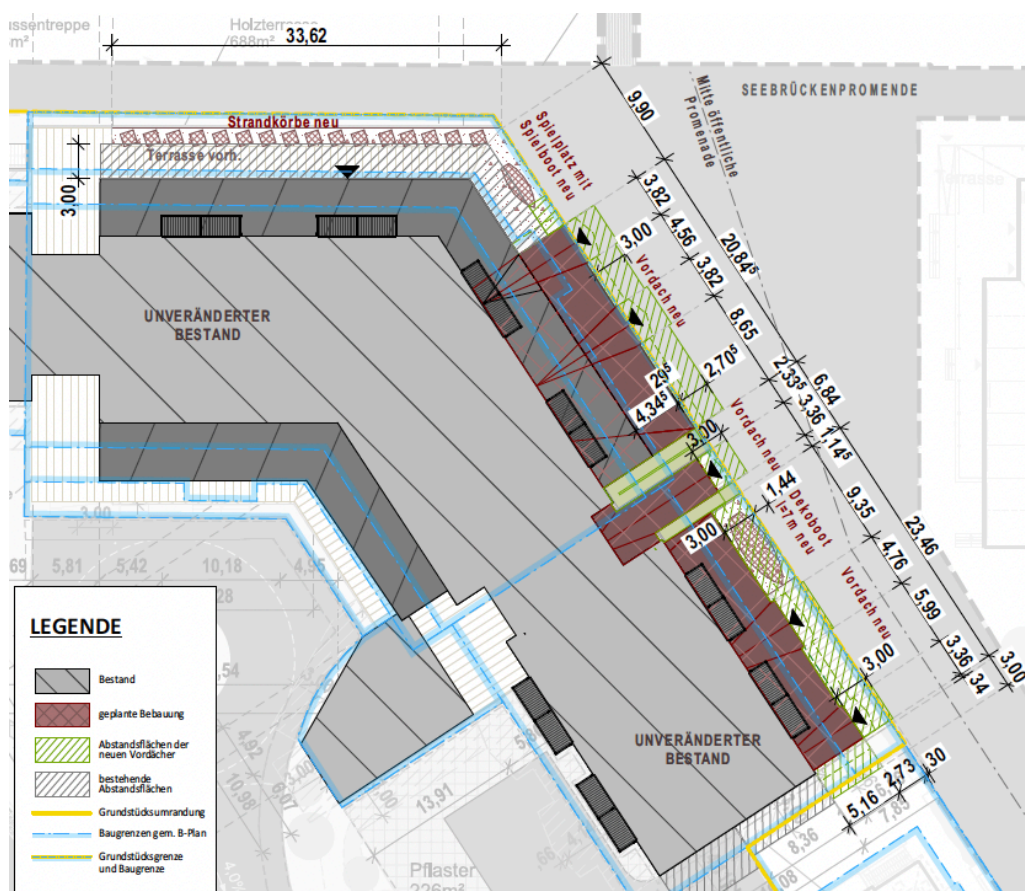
Auszug Lageplan 1.2 mit Darstellung der Baugrenzen lt. rechtskräftigem B-Plan (Quelle: Architekturbüro Ladehoff, Stand 05-2023)
